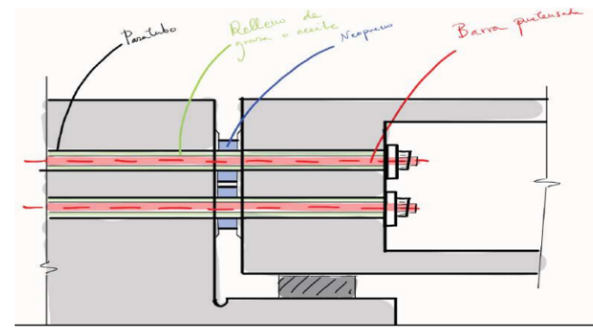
Croquis de punto fijo mediante barras pretensadas y apoyos elastoméricos.
